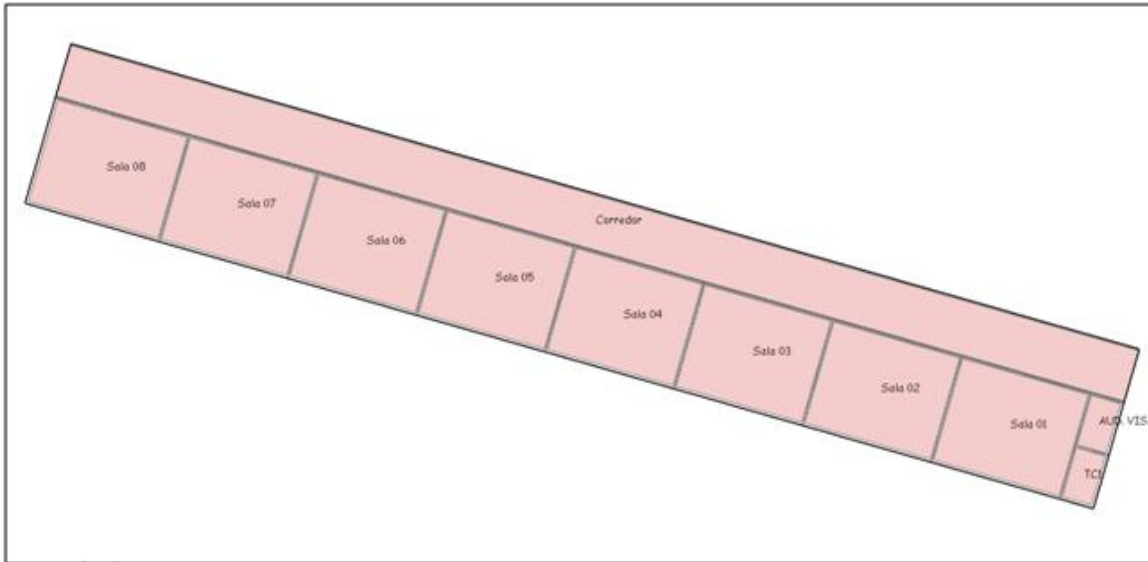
Salas de aula, salas de apoio e corredor do 1º pavimento
